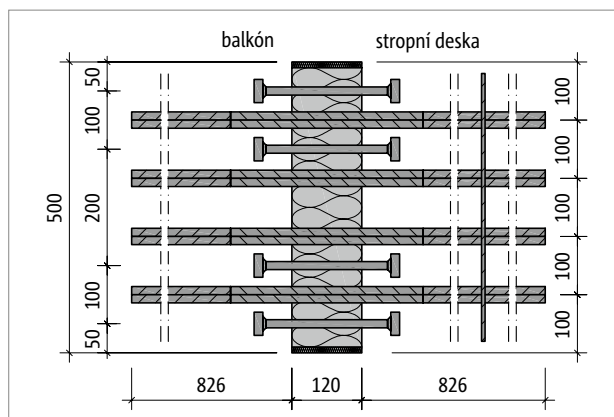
Schöck Isokorb® XT typ QP-V1: Půdorys prvku
